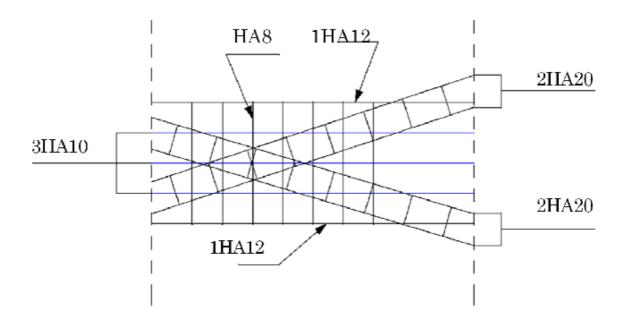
Schéma de ferraillage du linteau Pour les étages (sauf 9 et10).
